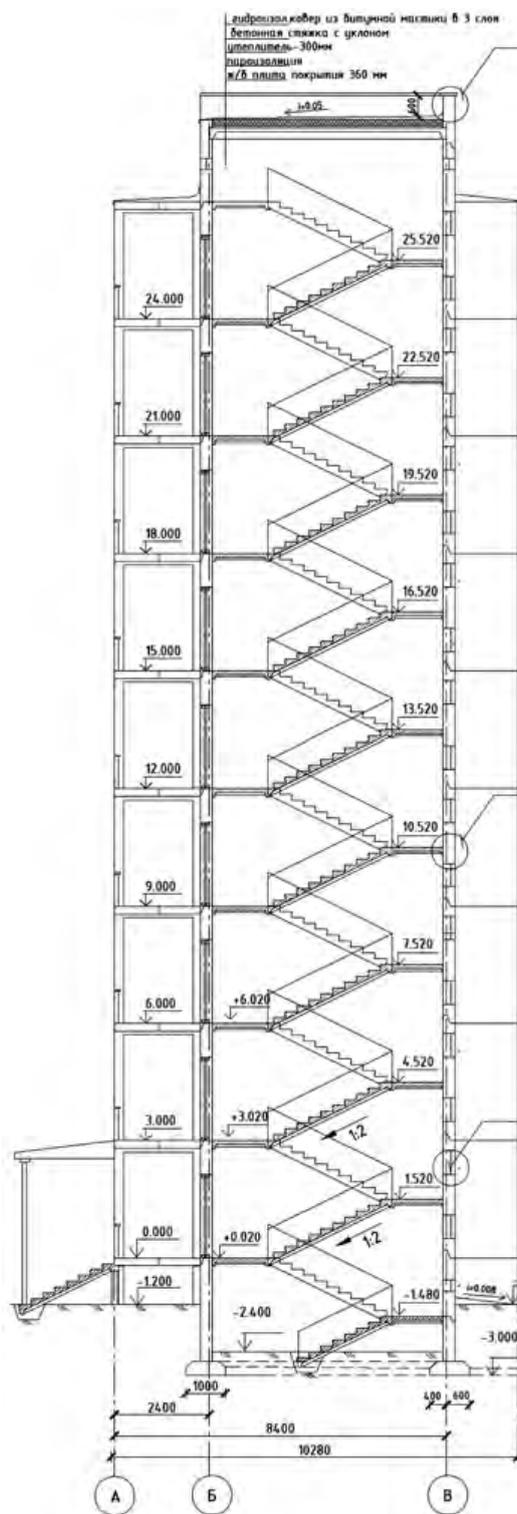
Разрез по лестничной клетке галерейного здания с вентилируемым холодным чердаком
